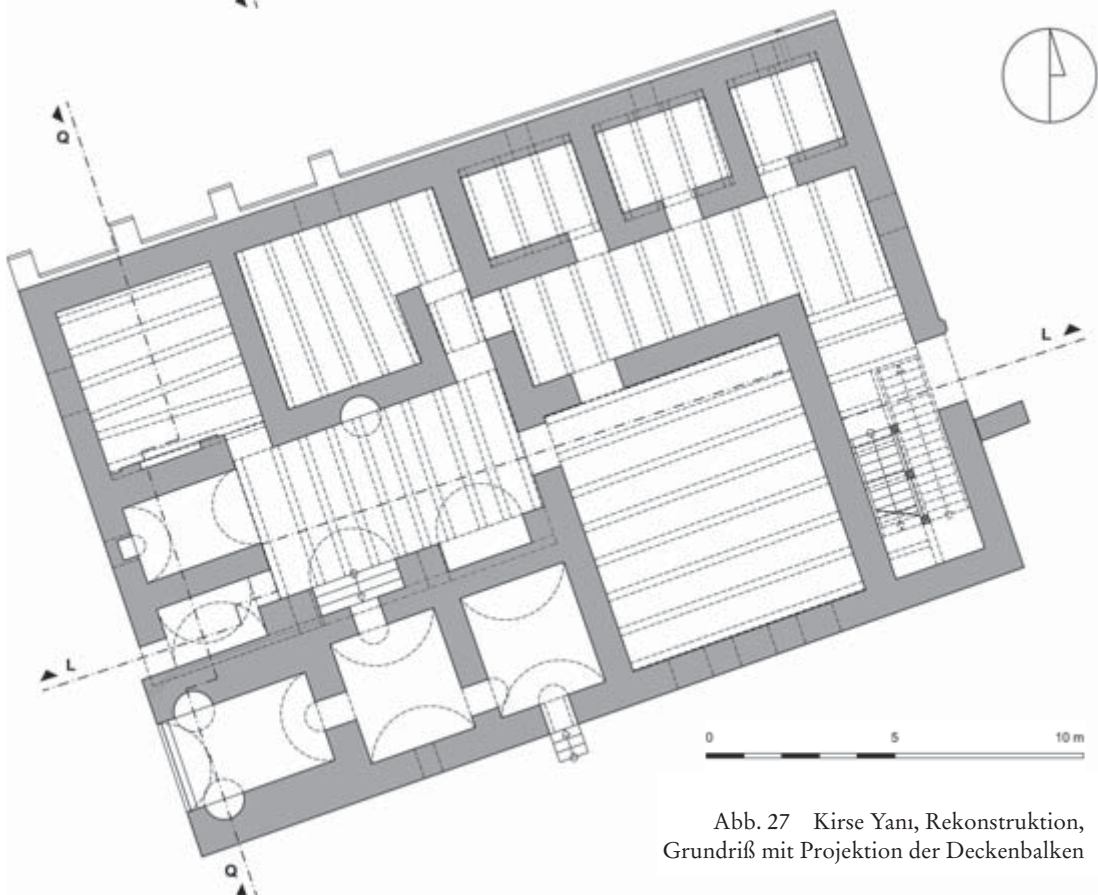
Kirse Yanı, Rekonstruktion, Grundriß mit Projektion der Deckenbalken
